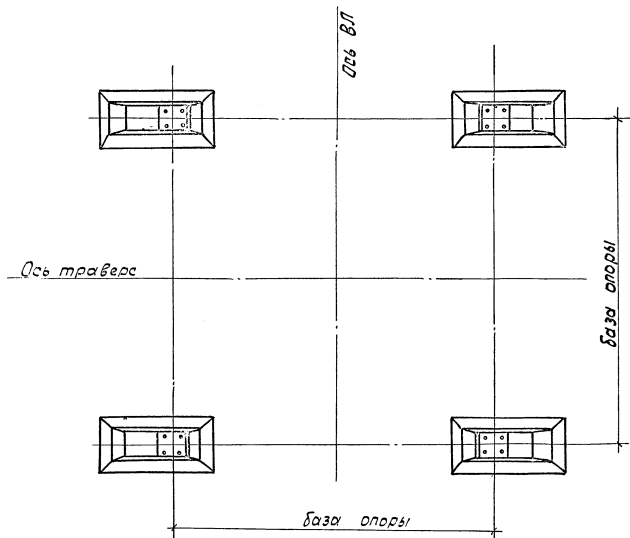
Конструкции унифицированных железобетонных элементов фундаментов
